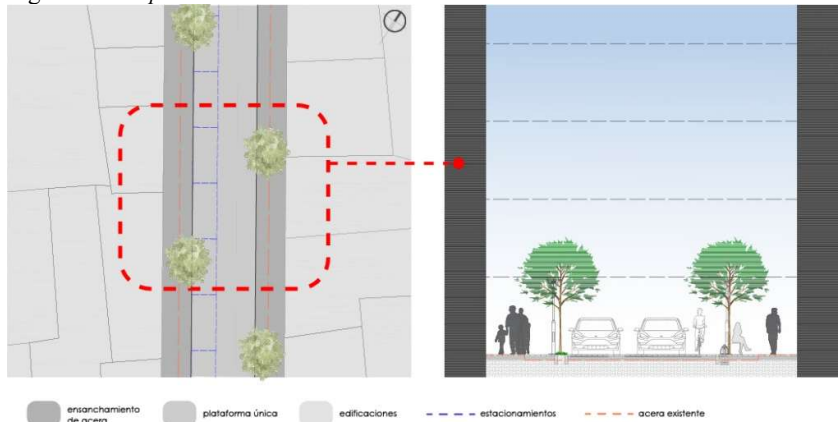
Implantación de la propuesta para el mejoramiento del espacio público para la calle Tomás Sevilla.
